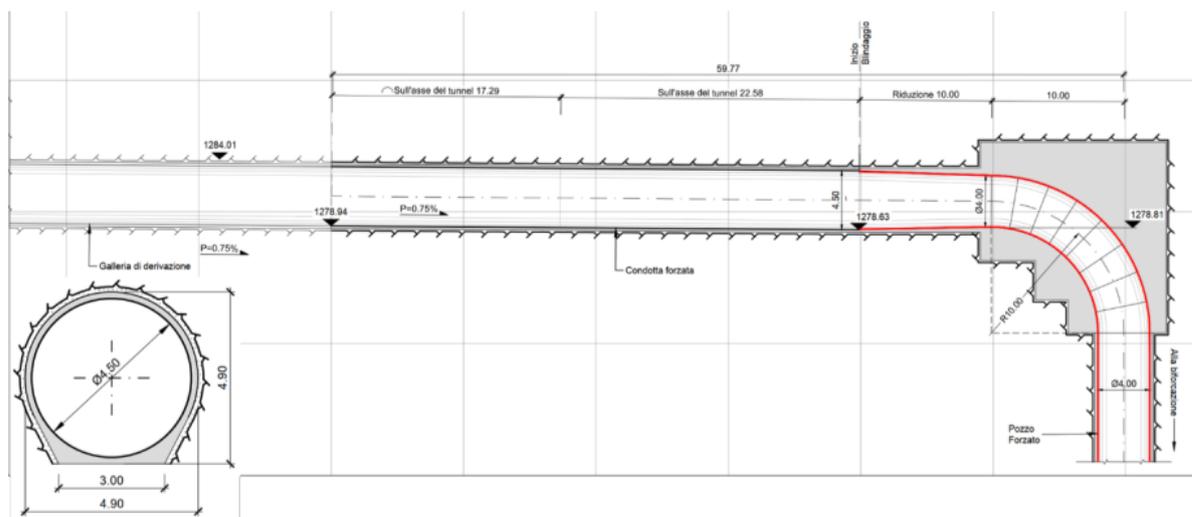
Nuova condotta forzata – profilo e sezione tipo
